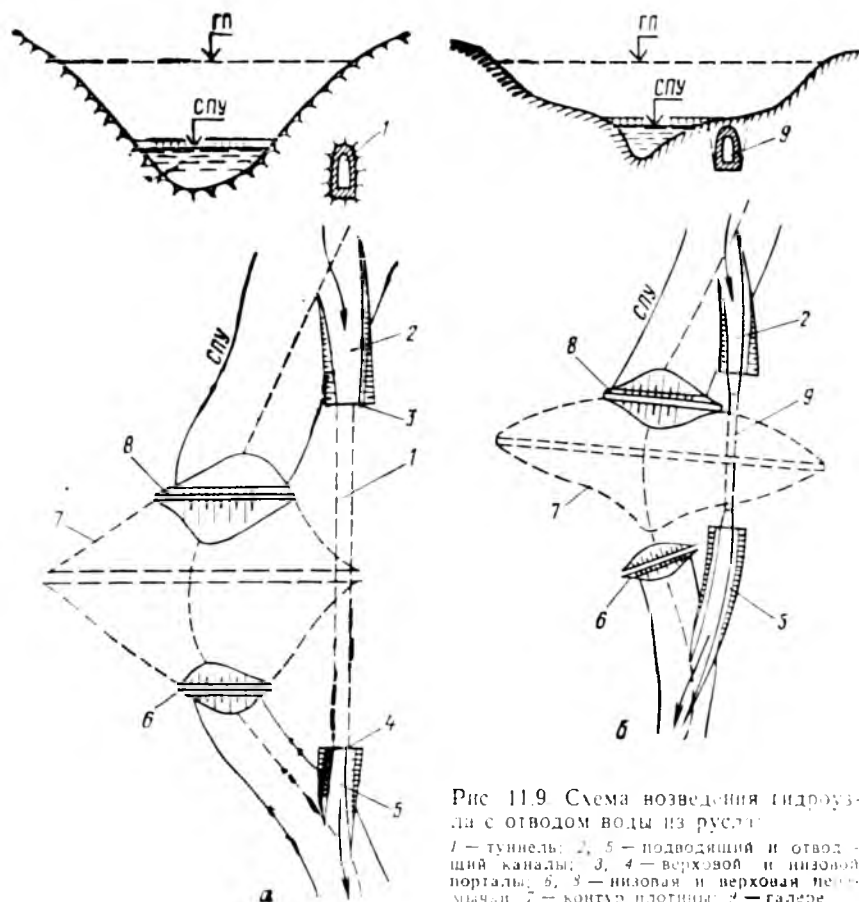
Схема возведения гидроузла с отводом воды из русла
